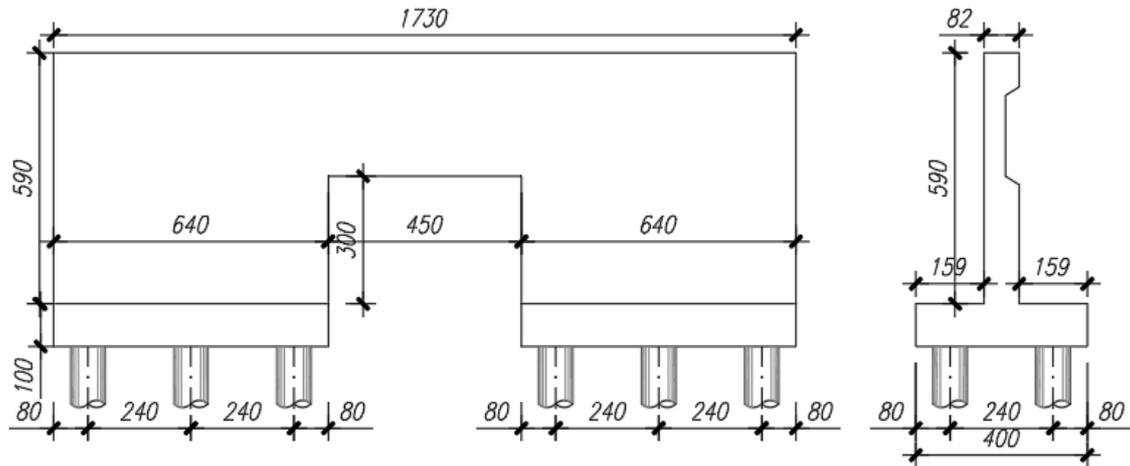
Prospetto e sezione portale di scavalco L=4,50m
